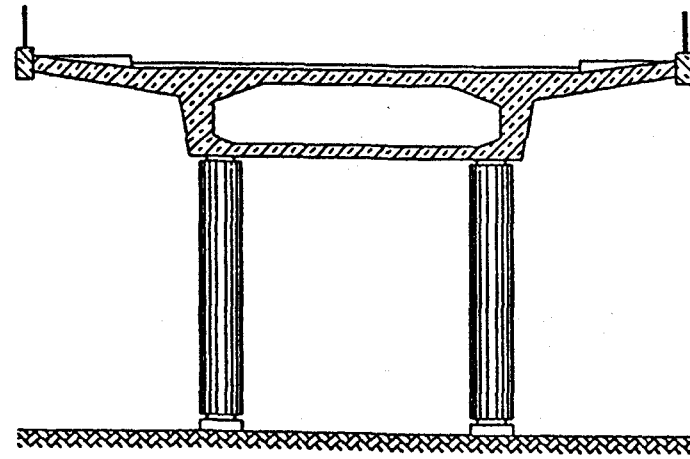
Filary żelbetowe dla przęseł płytowych [8]
